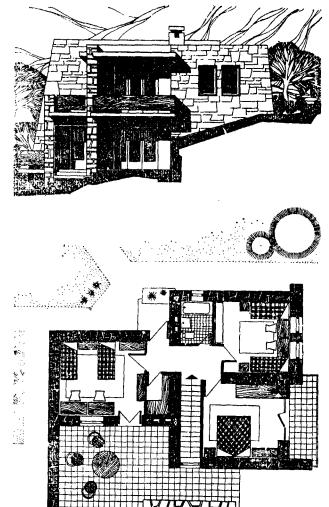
Одноквартирный дом южиого типа с квартирой в двух этажах, на склоне горы. План 1-го этажа, фасад
